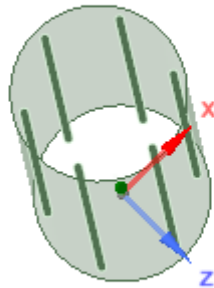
VUE DE L'ARMATURE ET DU TUBE SUR LA GEOMETRIE ANSYS
